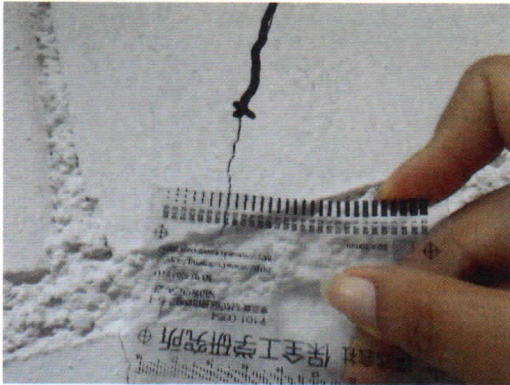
Espesor de grieta de 0.4mm en ladrillo de la cara Norte para una distorsión de 1/800.
